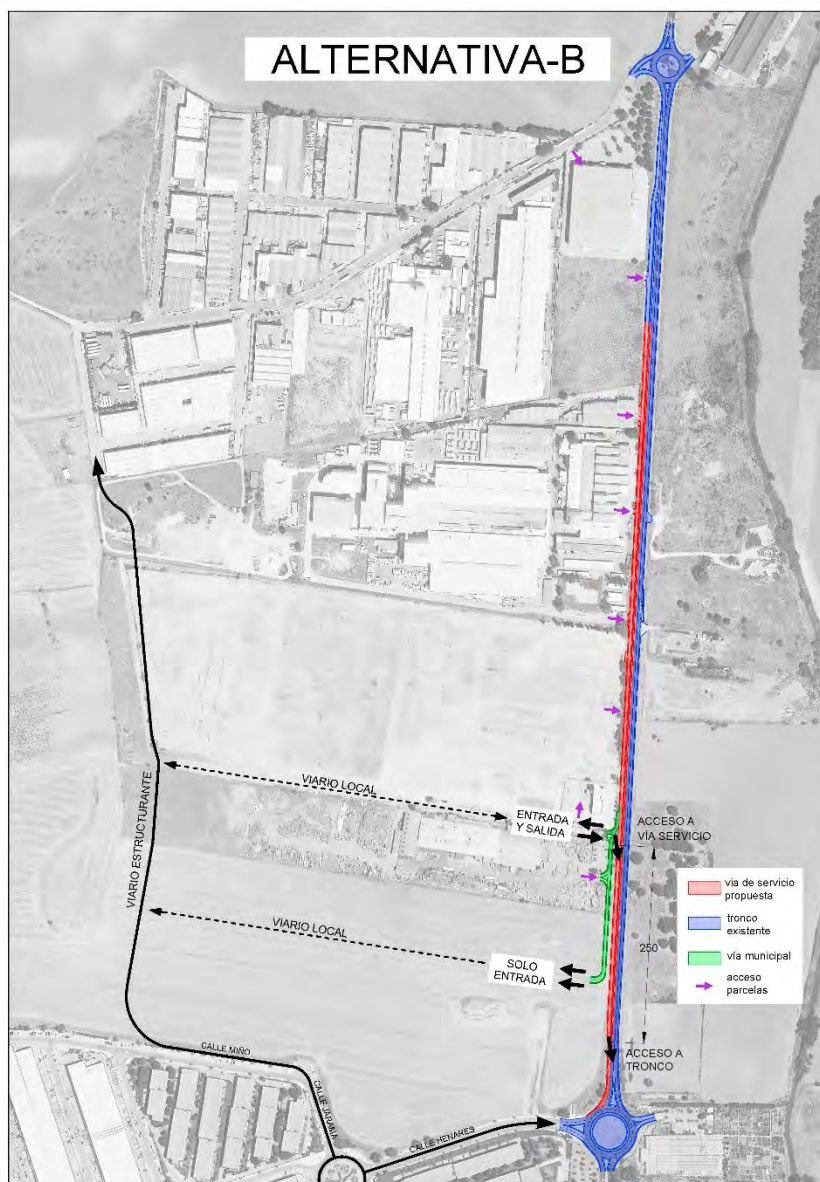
Plano Ordenación alternativa Beta. Fuente Diaplan SAP.
